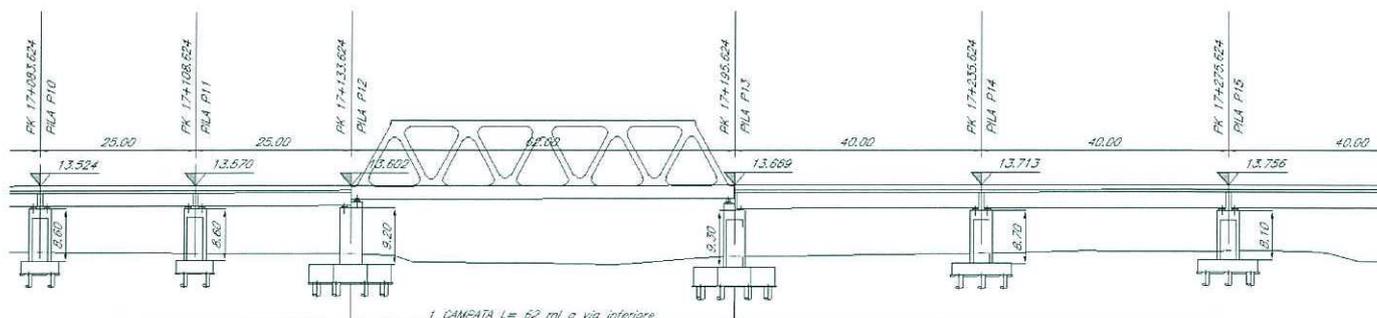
Prospetto del viadotto in corrispondenza del fiume Stella.
